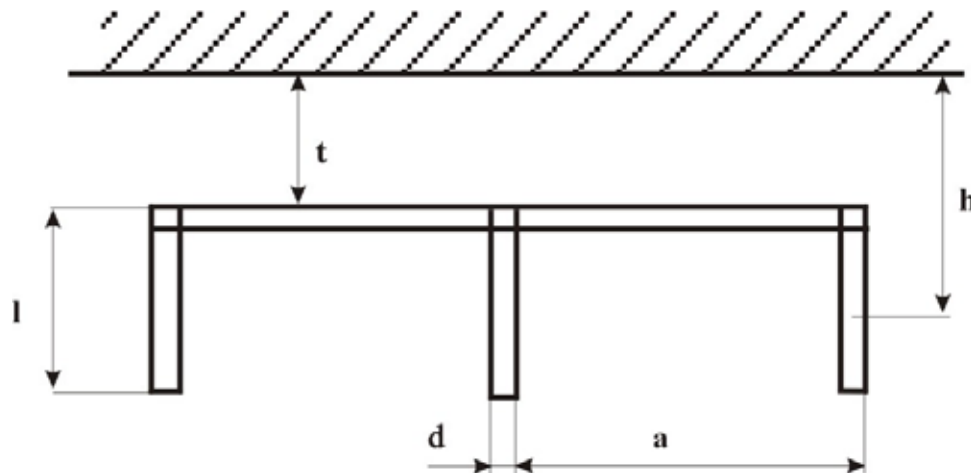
Схема установки защитного заземления  $l = 3000$  [мм];
